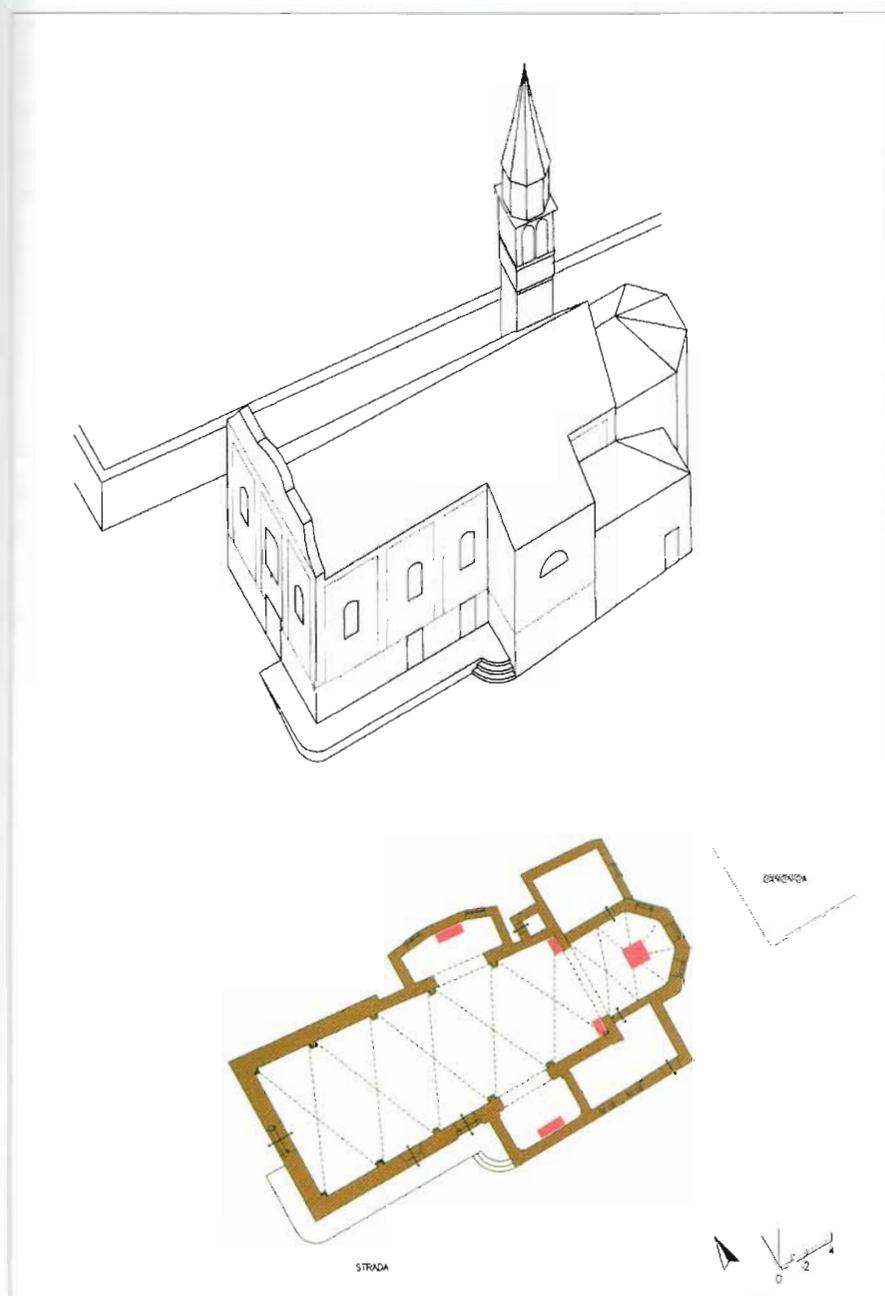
Pianta e assonometria delle chiesa ottocentesca (fase V). XIX secolo.
